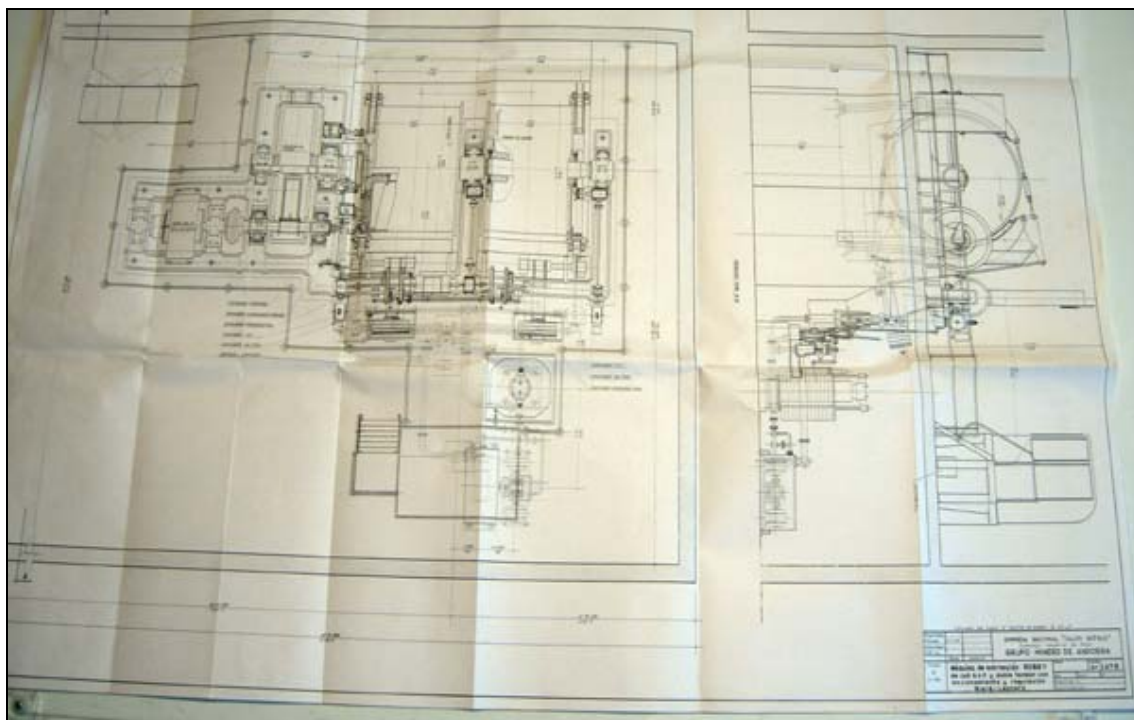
Plano donde se refleja la instalación de la máquina ROBEY en la sala de máquinas del pozo San Juan.
